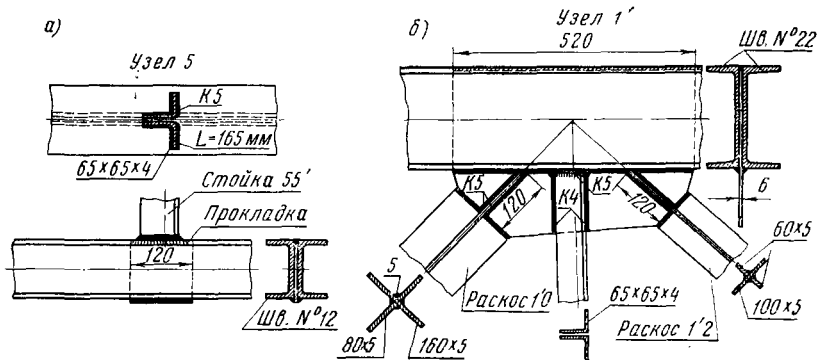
К расчету сварных соединений в узлах главной фермы
